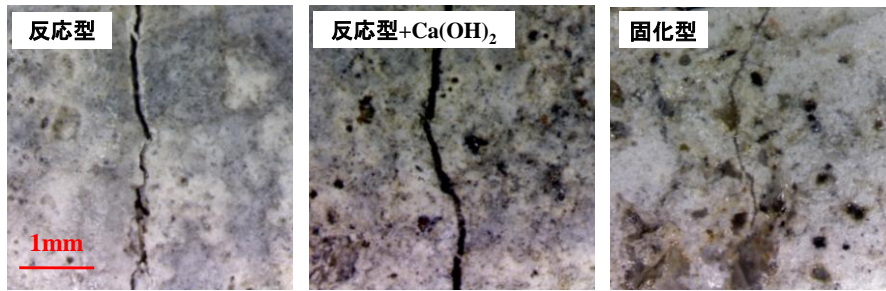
ひび割れ部の拡大写真（塗布後 7 日）
